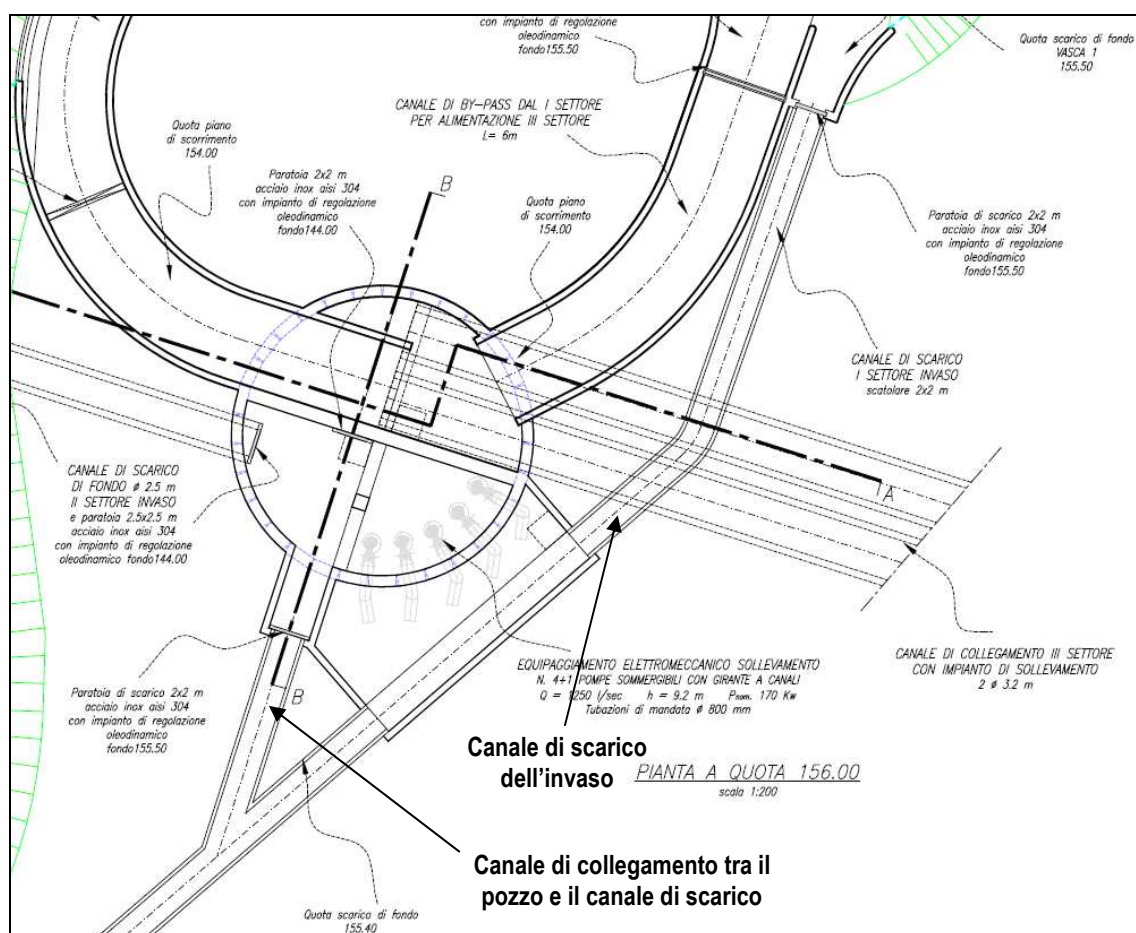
Planimetria con indicazione delle opere di scarico dell'invaso
